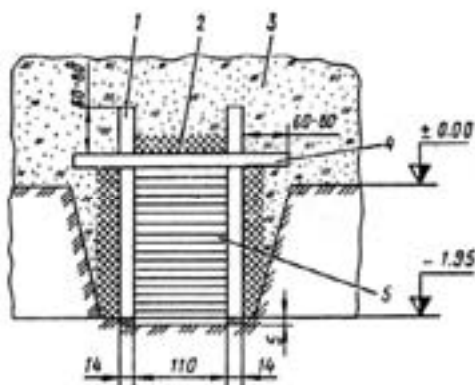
Швидкоспоруджуване сховище на 10 чол. із залізобетонних перемичок:
